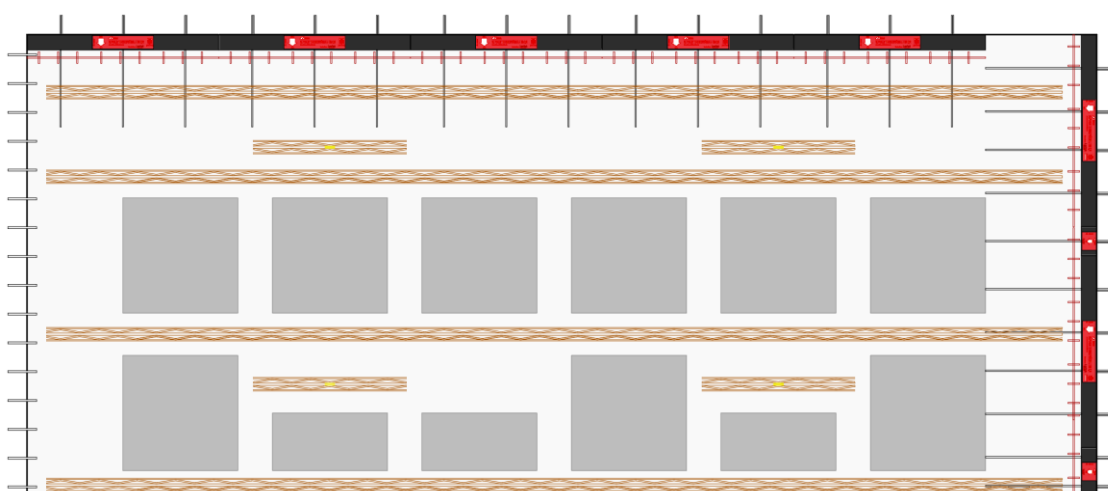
prédalle d'angle - procédé Dalle WOODlite avec rupteurs ThermoPrédalle BA 0.2
